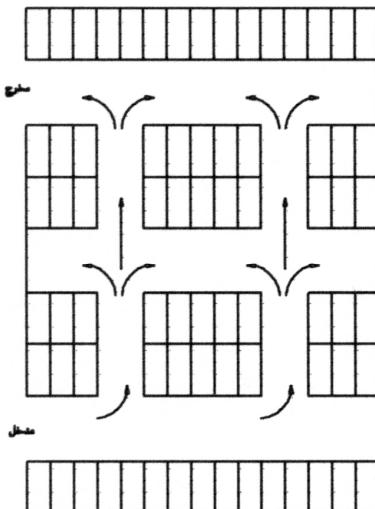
مسقط أفقي يوضح منحني ذو اتجاه واحد
